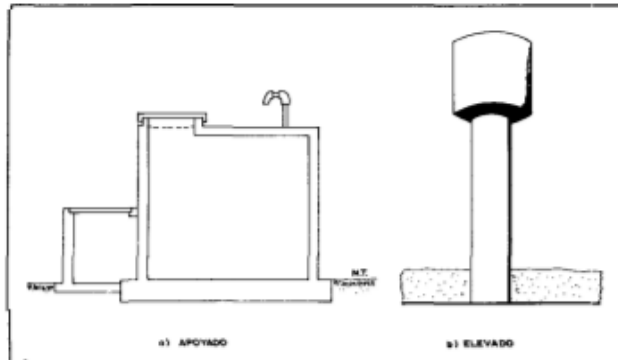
Tipos de reservorios: apoyado y elevado
